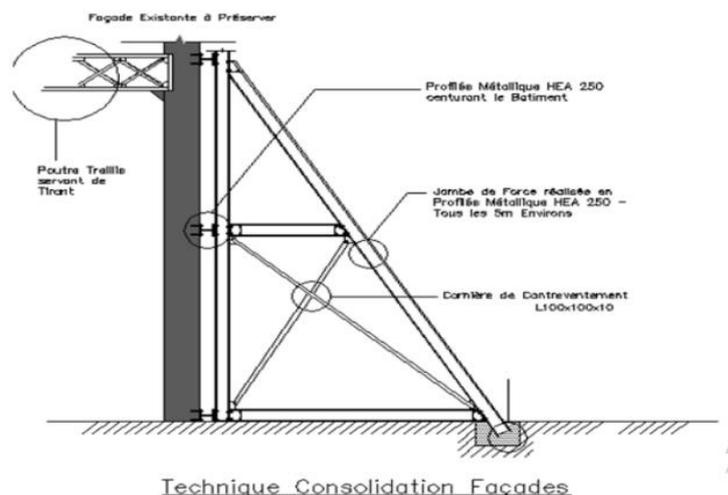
Étaieement et consolidation de la façade par des portiques en acier.
